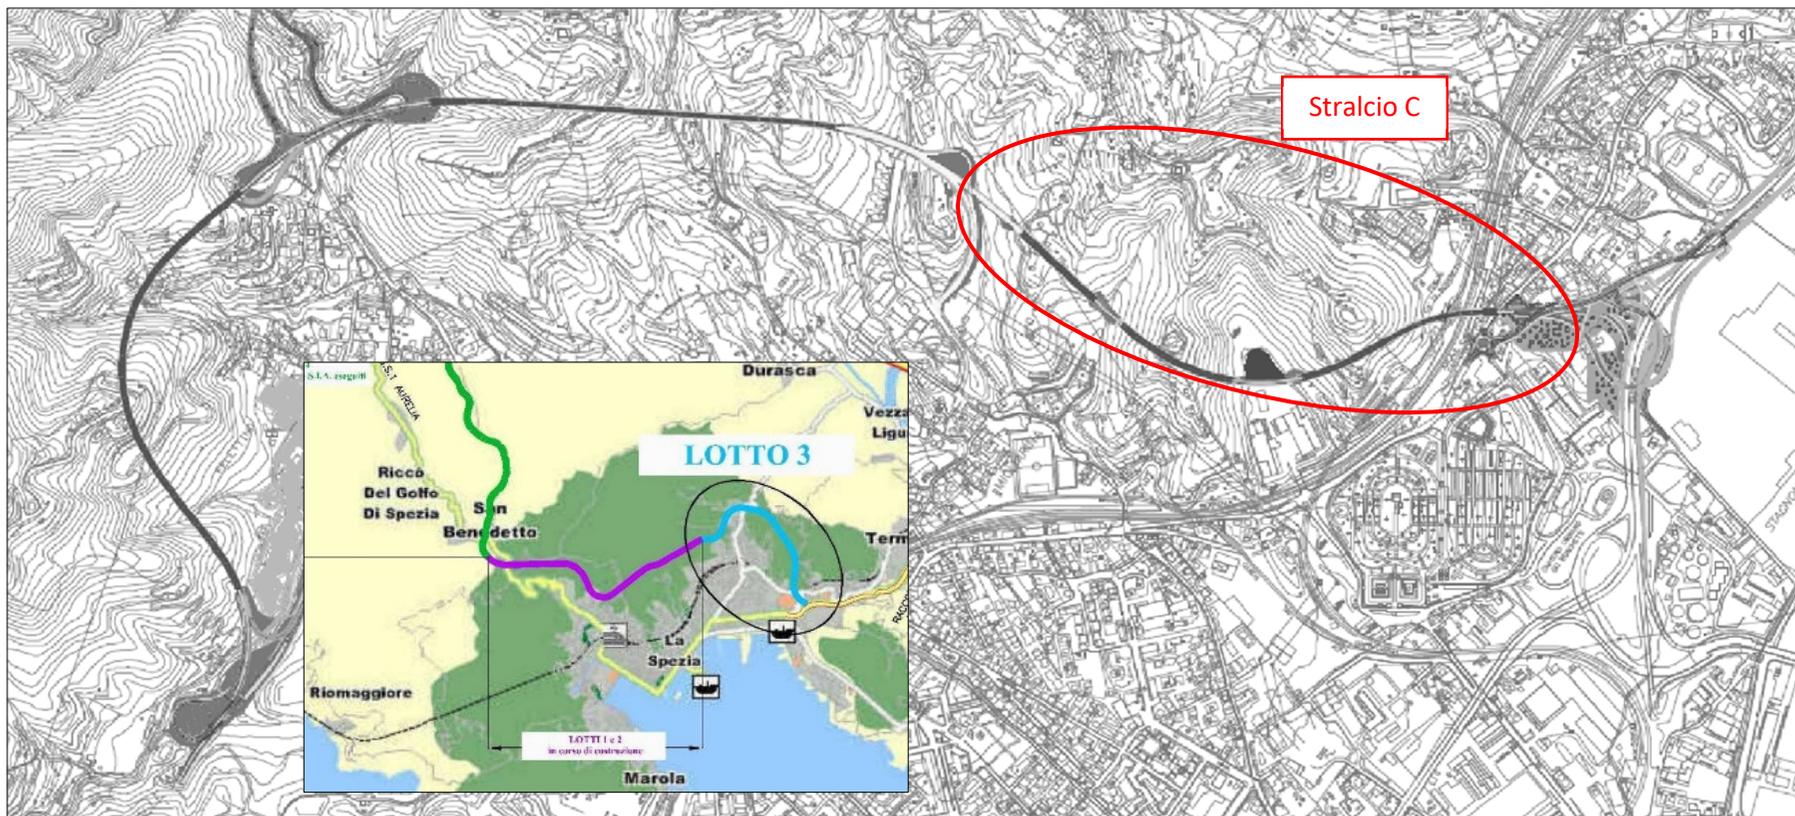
Schema planimetrico Viabilità di accesso all'Hub portuale di La Spezia - 3° Lotto
